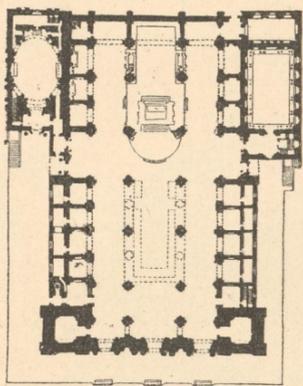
Grundriss der Cathedrale von Jaen.
